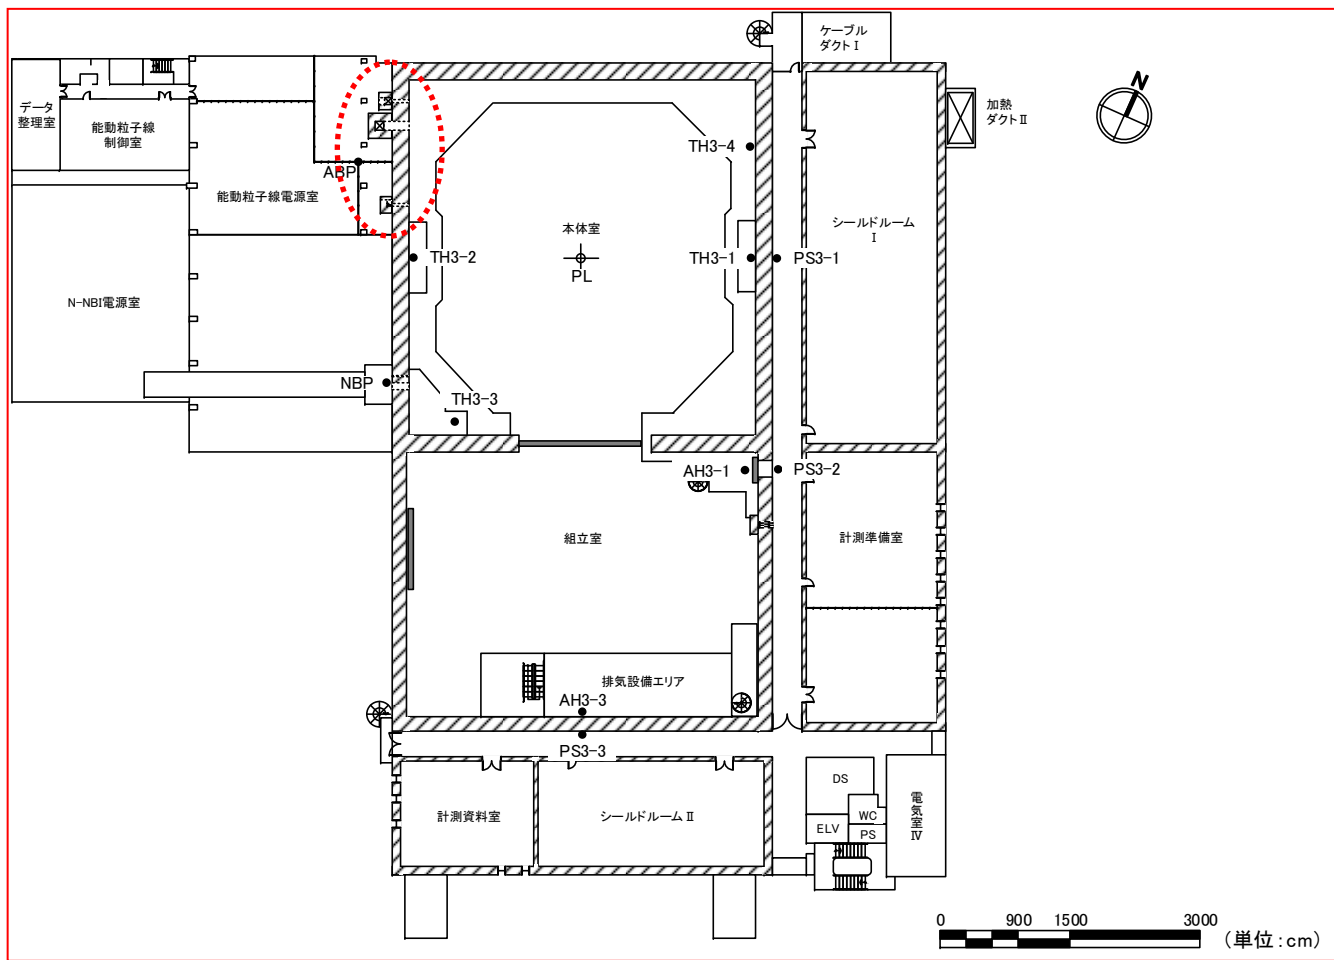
1. 5. 3 JT-60実験棟3階平面図 (単位: cm) (改修後)
